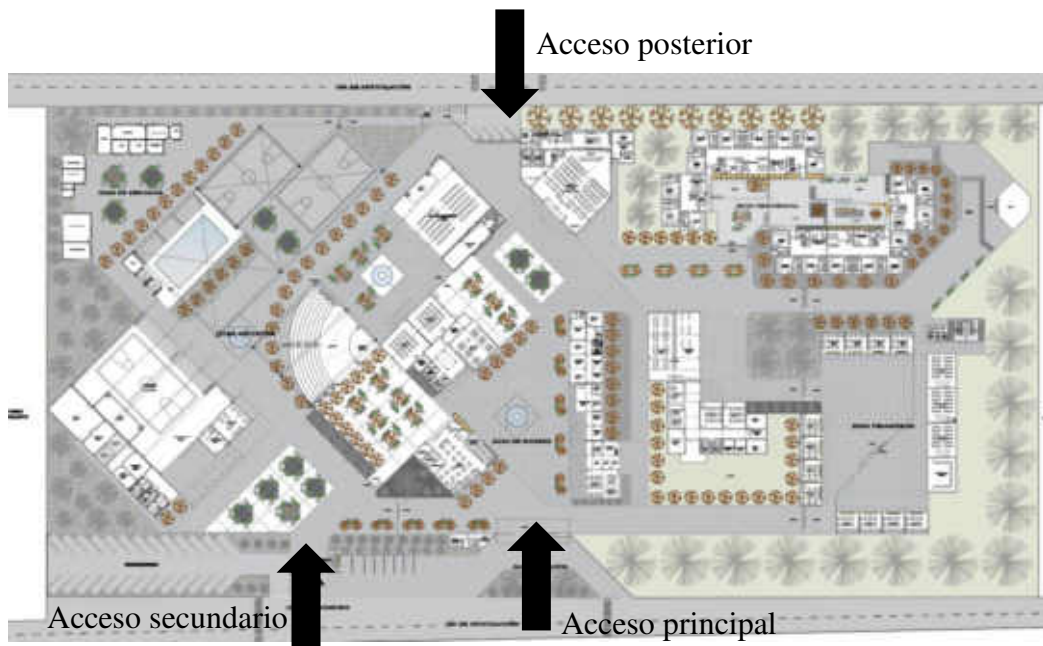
esquema de accesos en la planimetría del proyecto, fuente elaboración propia.
